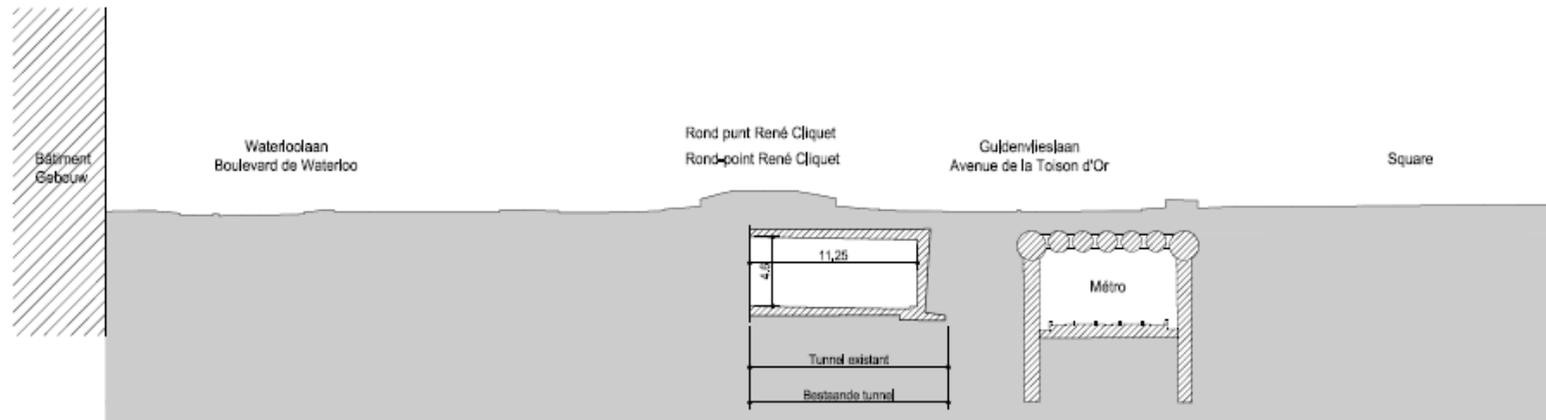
Coupe transversale 1 de la zone du projet dans la situation existante.
